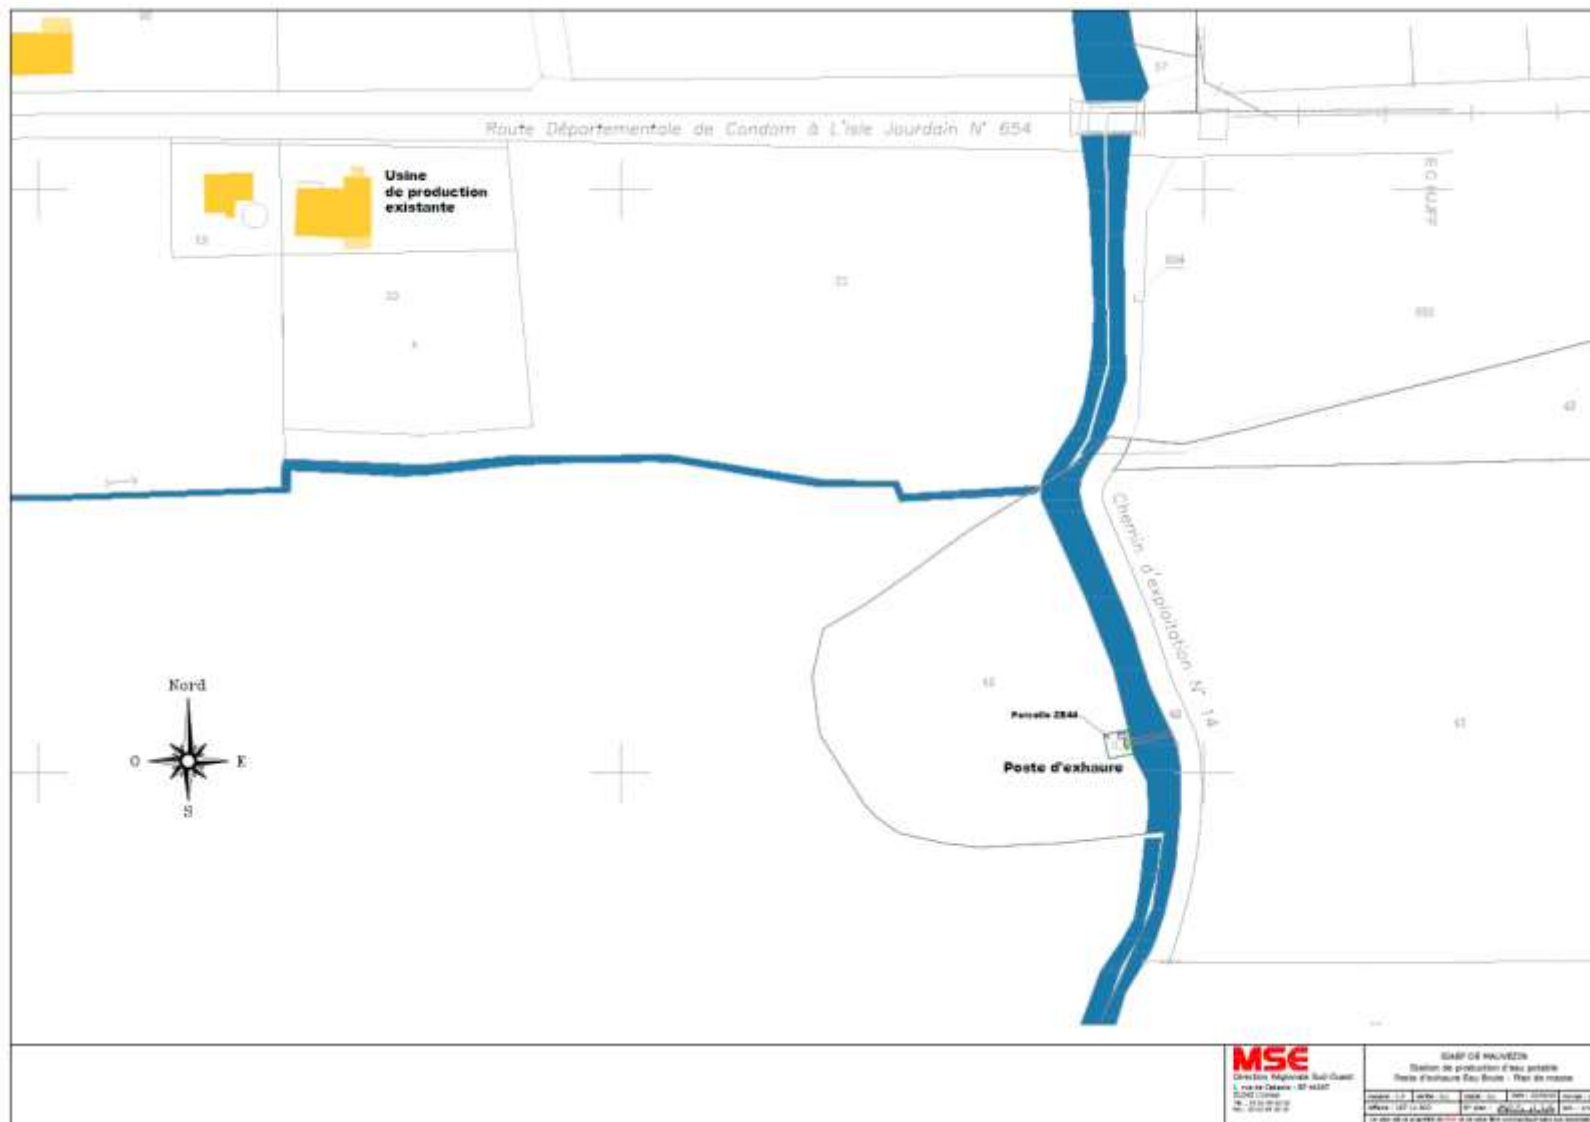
Poste d'exhaure eau brute (plan projet) – Plan de masse sur fond cadastral (Véolia)
